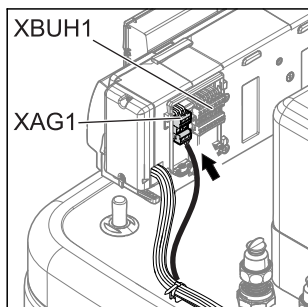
Elektrische Anschlüsse Gehäuserückseite (siehe Abschnitt 4.5.1) herstellen.
